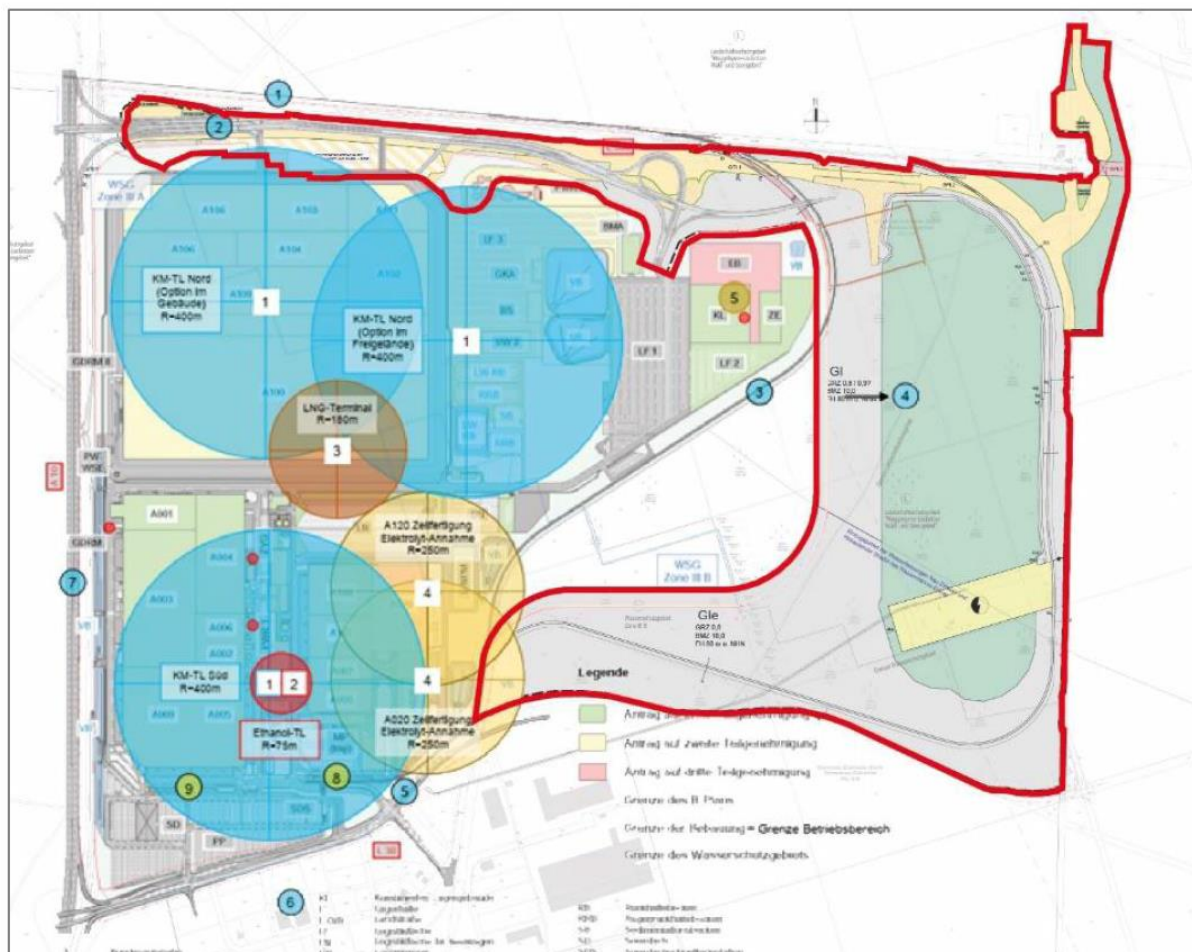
Lageplan angemessener Sicherheitsabstände nach KAS-18
